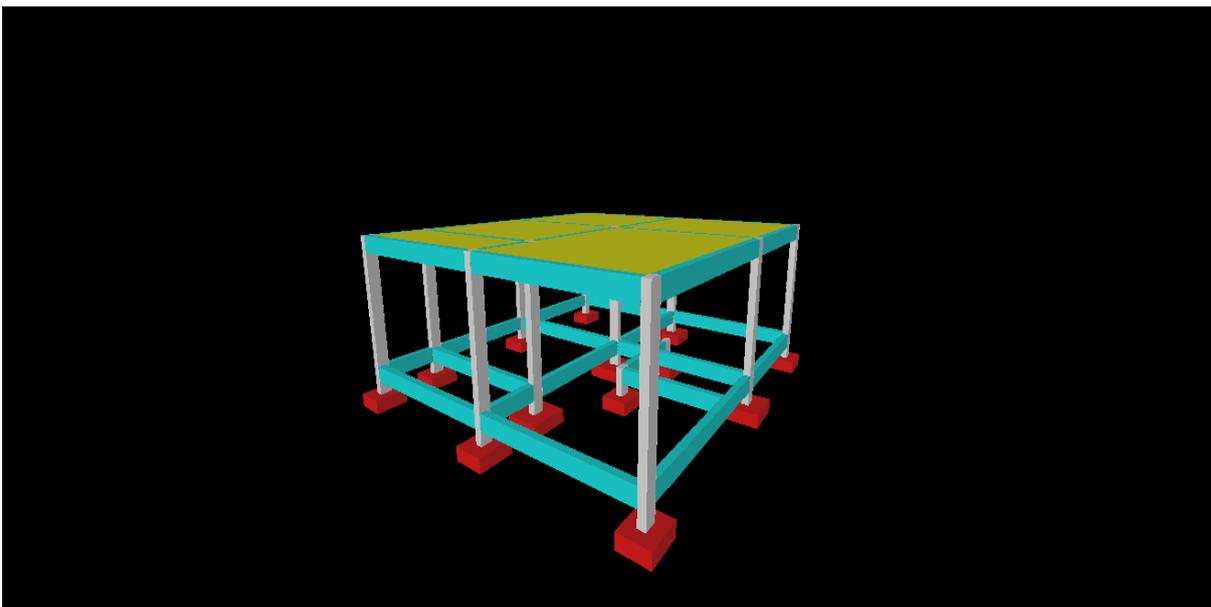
Projeto de Estrutura de Concreto Armado 3D
